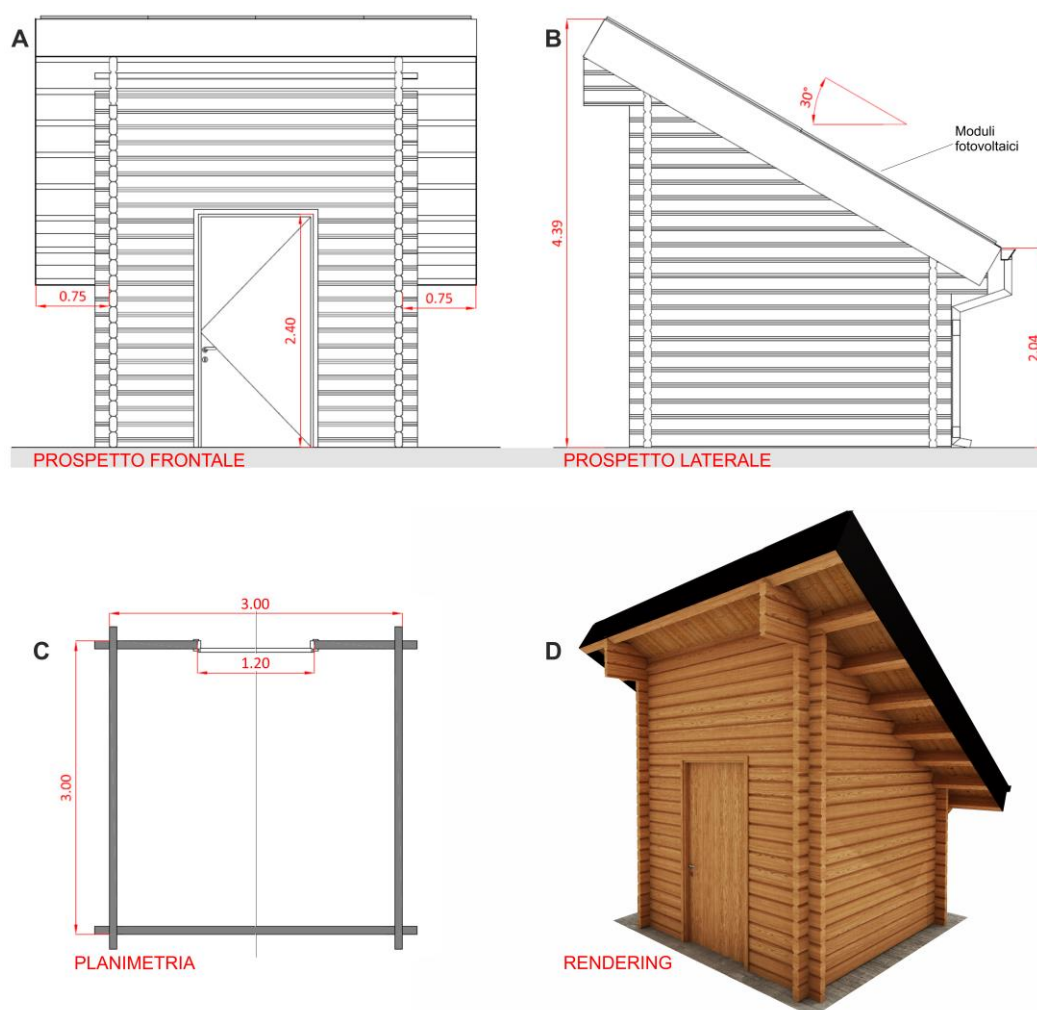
Prospetto frontale (A), prospetto laterale (B), planimetria (C) e rendering (D) della casetta in legno che verrà realizzata per alloggiare un gravimetro quantico.
